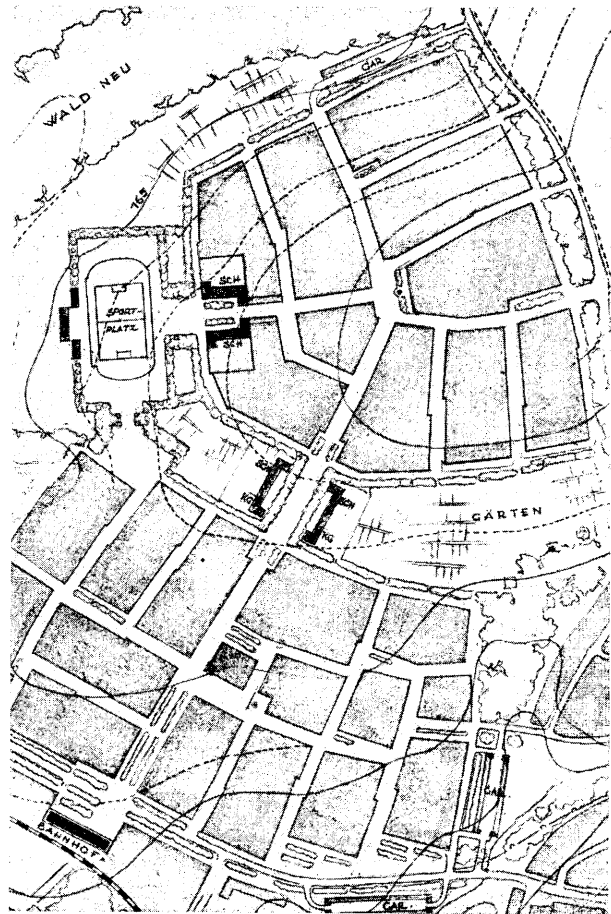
Ausschnitt aus einem Strukturbebauungsplan
